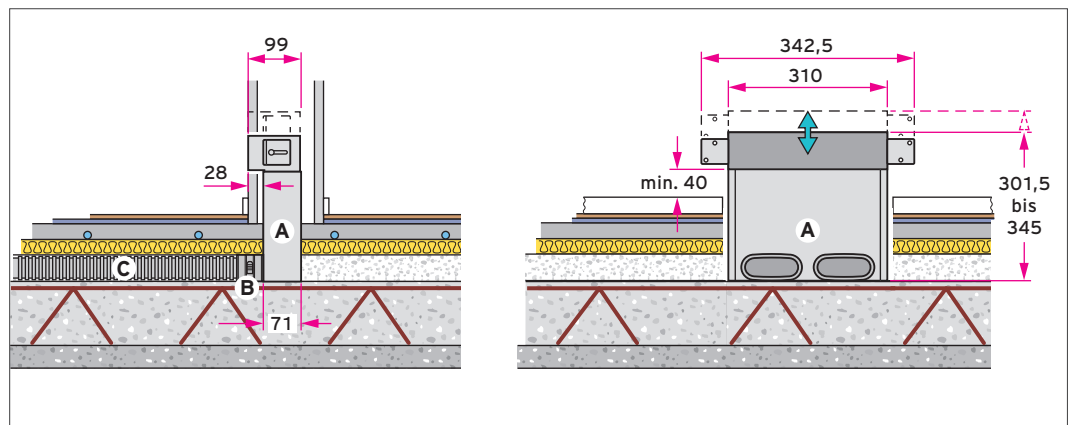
Rechteckiger Luftauslass, Wandmontage - Verlegung im Fußbodenaufbau
